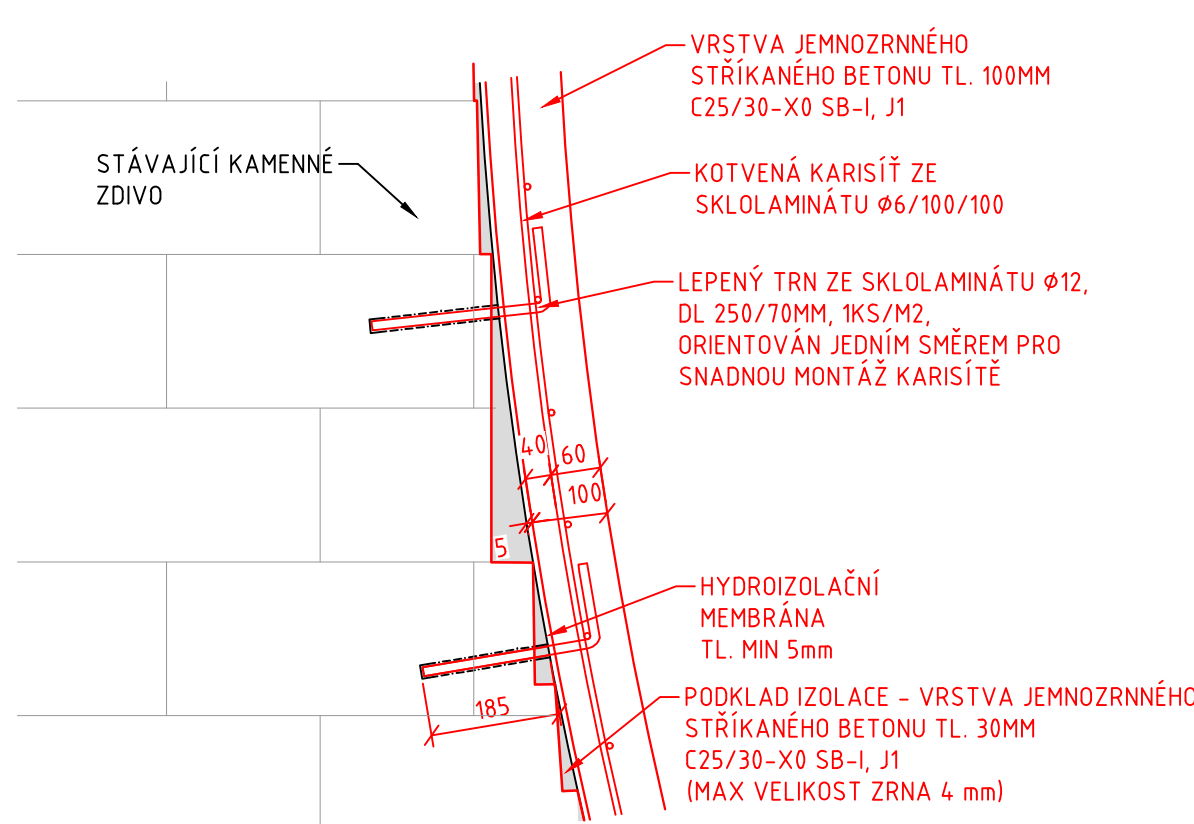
DETAIL "B" SCHÉMA NÁVRTNÝCH BODŮ
